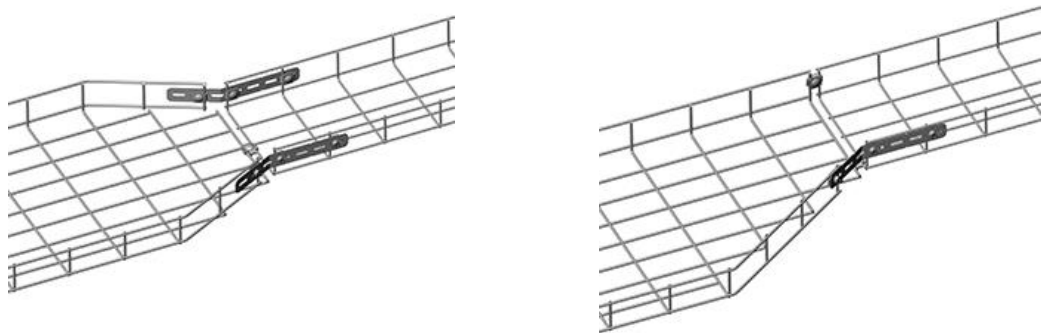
Пример изготовления перехода с одной ширины лотка на другую
